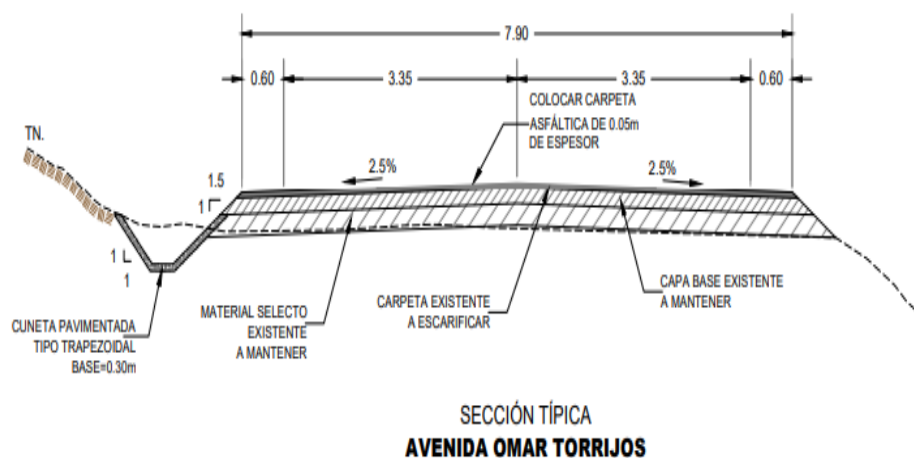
Sección típica Ave. Omar Torrijos. Fuente: Planos del proyecto
